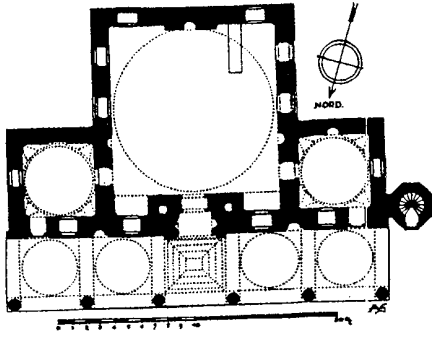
مسقط أفقى للمسجد الملحق
